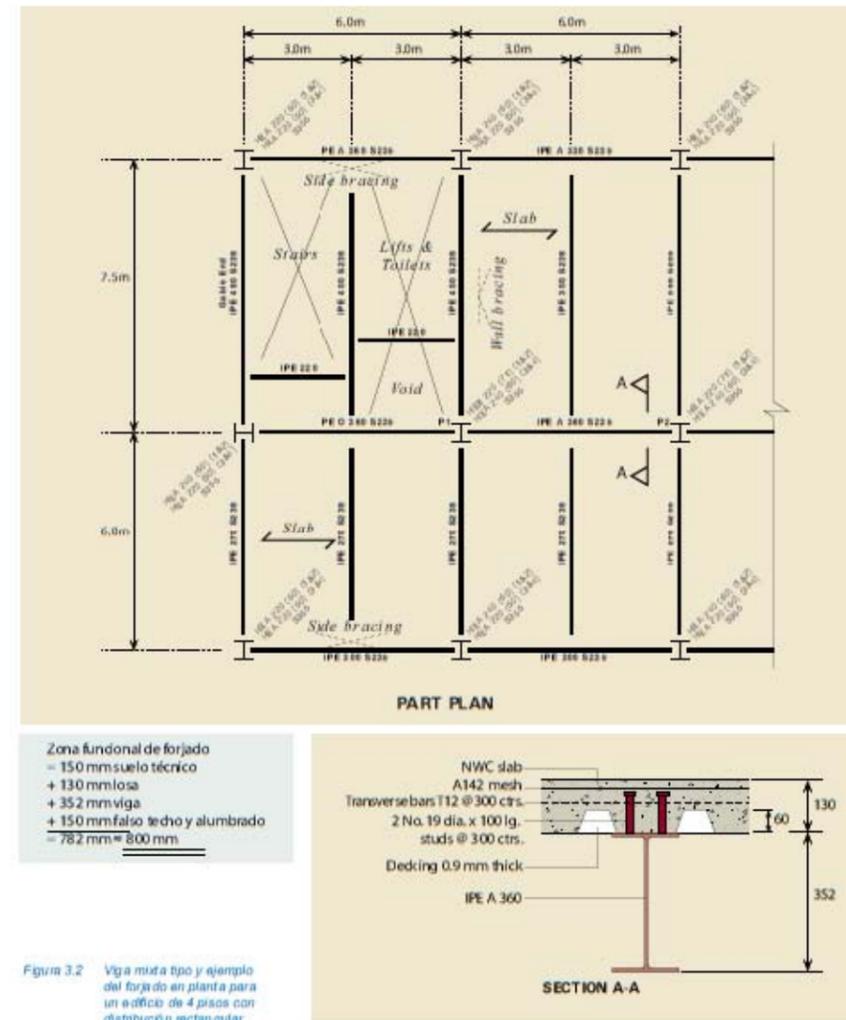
Viga mixta tipo y ejemplo del forjado en planta para un edificio de 4 pisos con distribución rectangular
